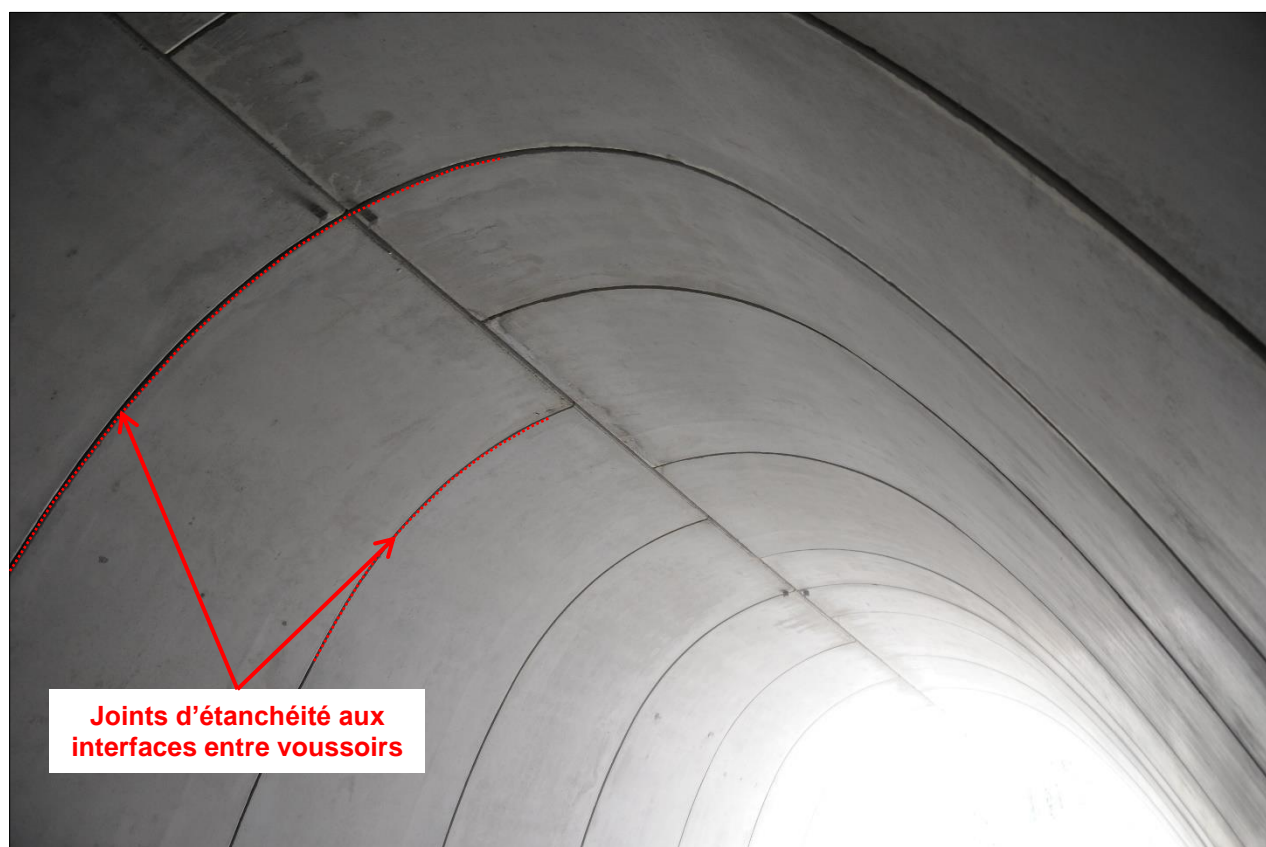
Vue sur les voussoirs en béton et la clé de voûte de l'ouvrage hydraulique
